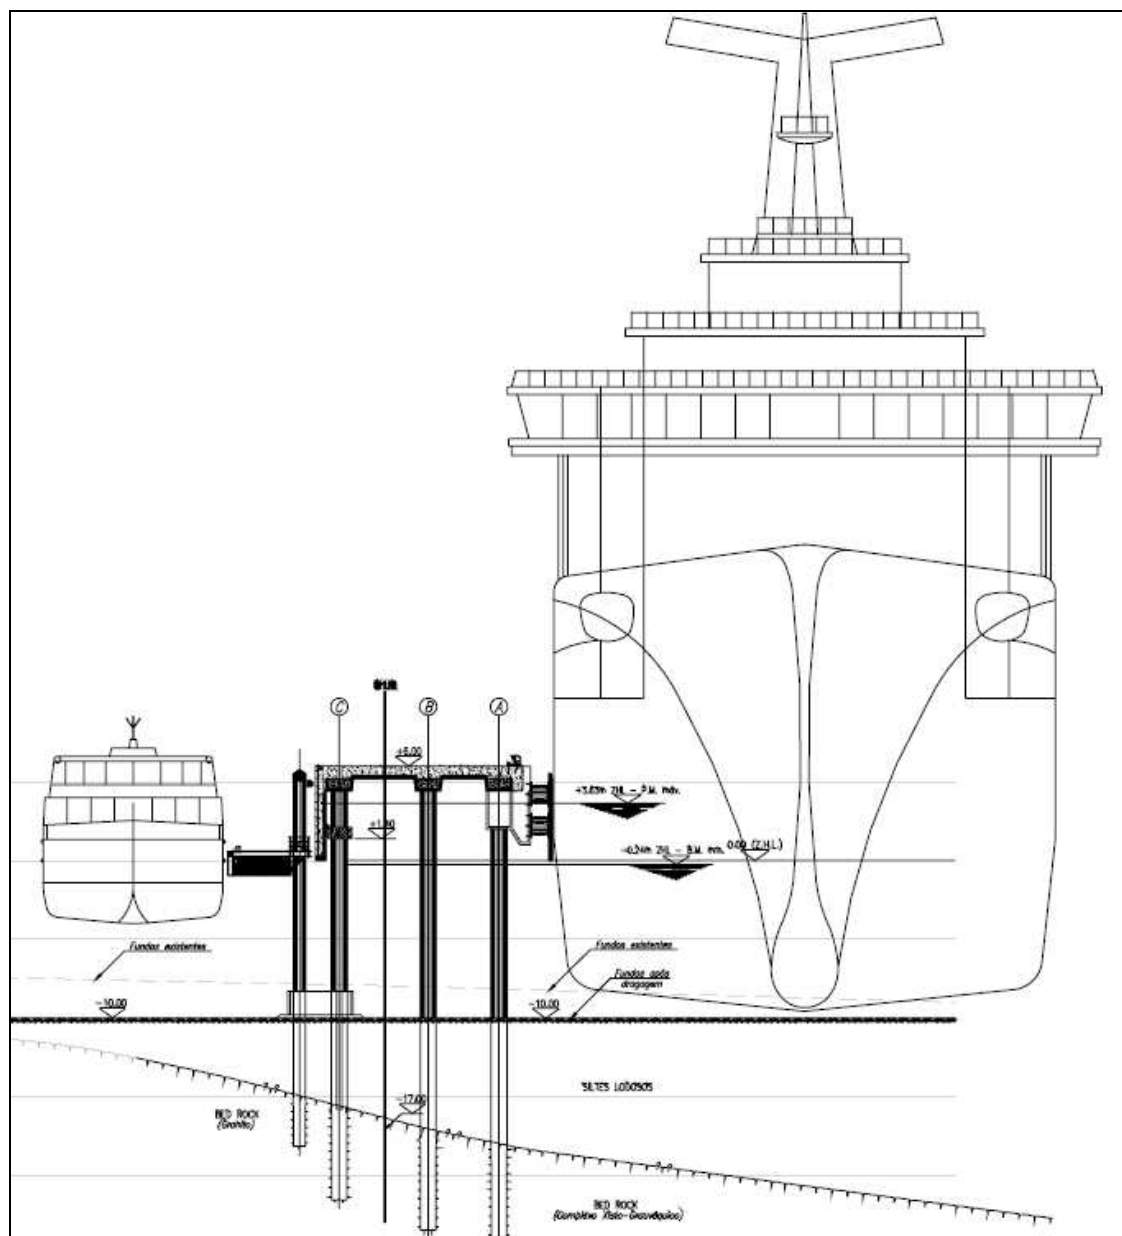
Corte do arranjo geral do Cais Acostável e Flúvio-Marítimo (imagem do projecto de execução).
